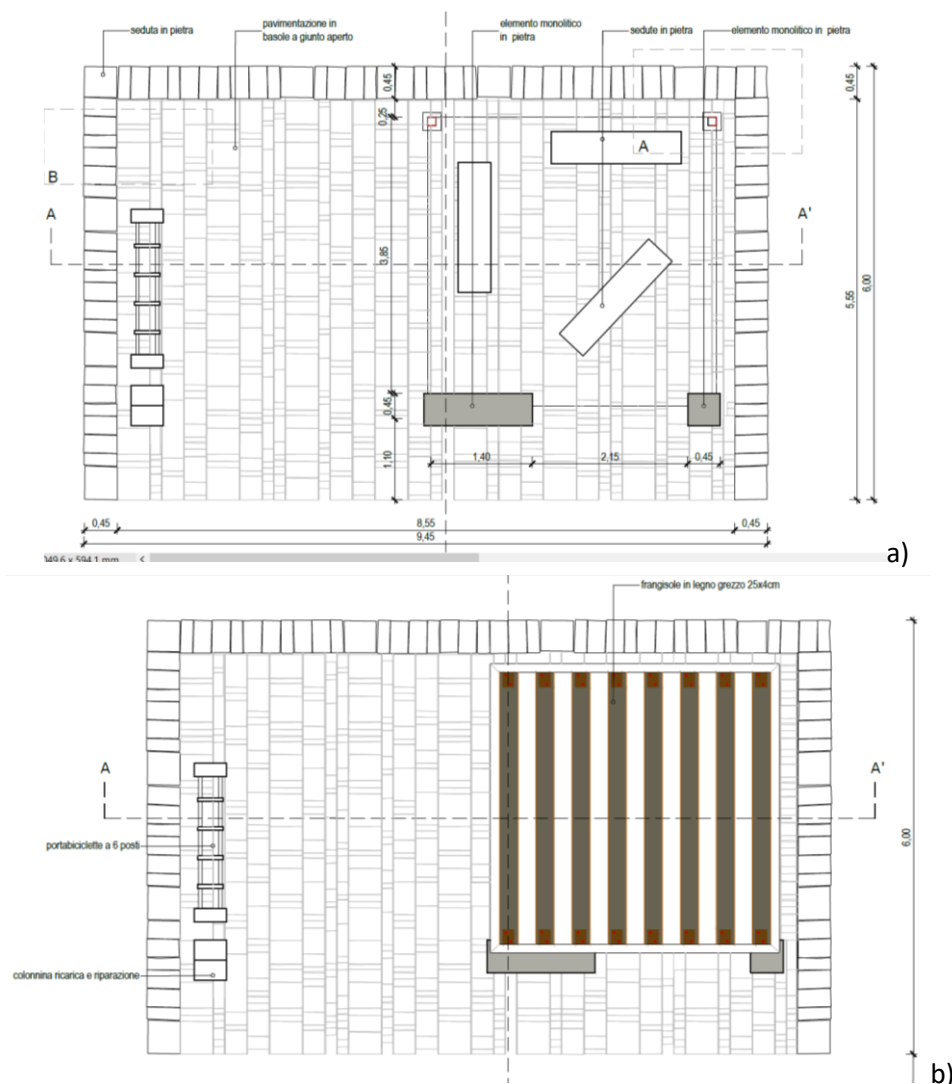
Tipologico area di sosta: sezione a) e vista dall'alto b)
